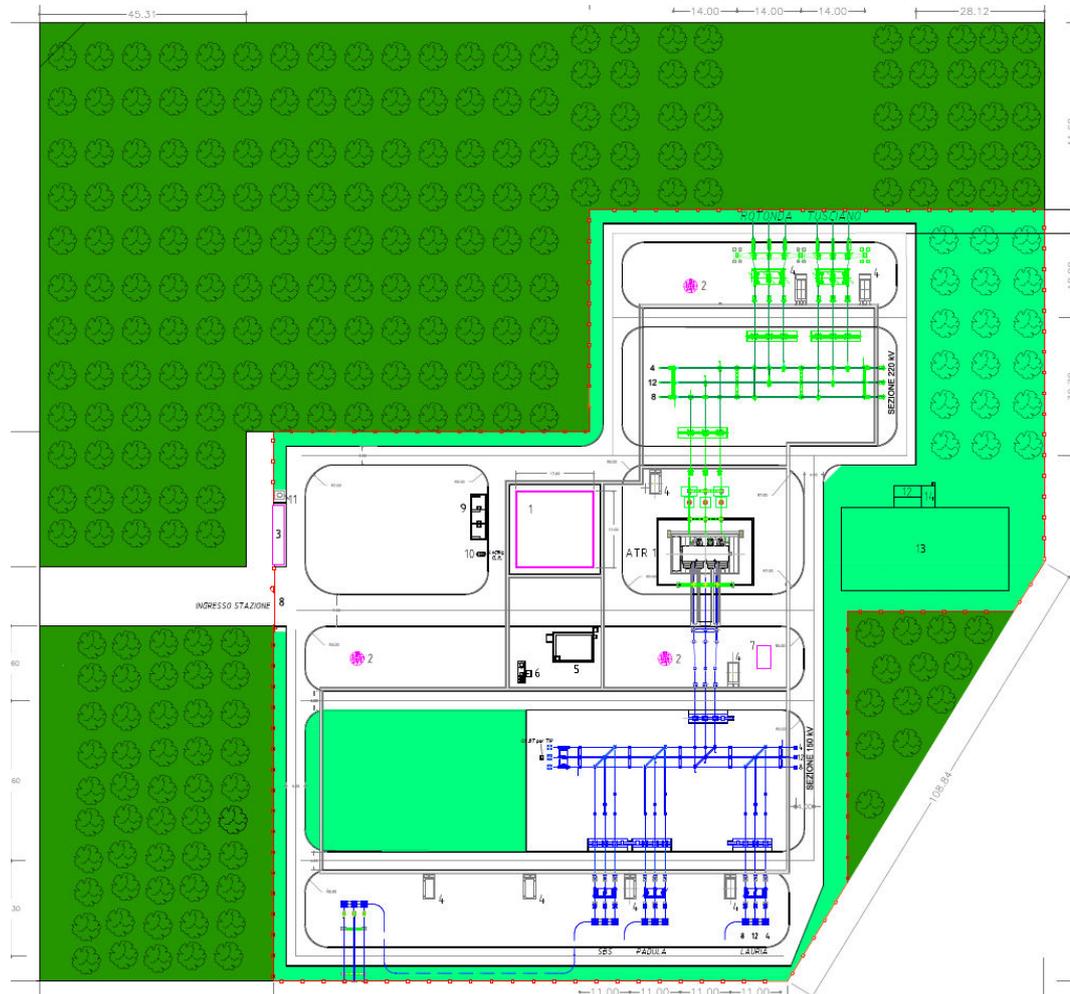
Planimetria elettromeccanica generale – Planimetria di variante
